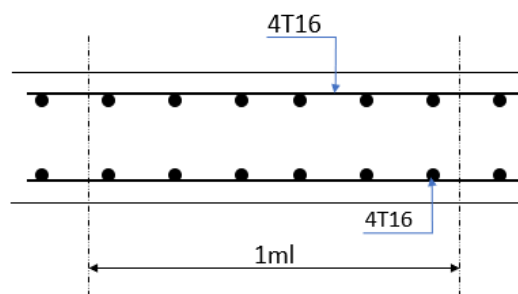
Schéma Ferrailage de la dalle du radier.
